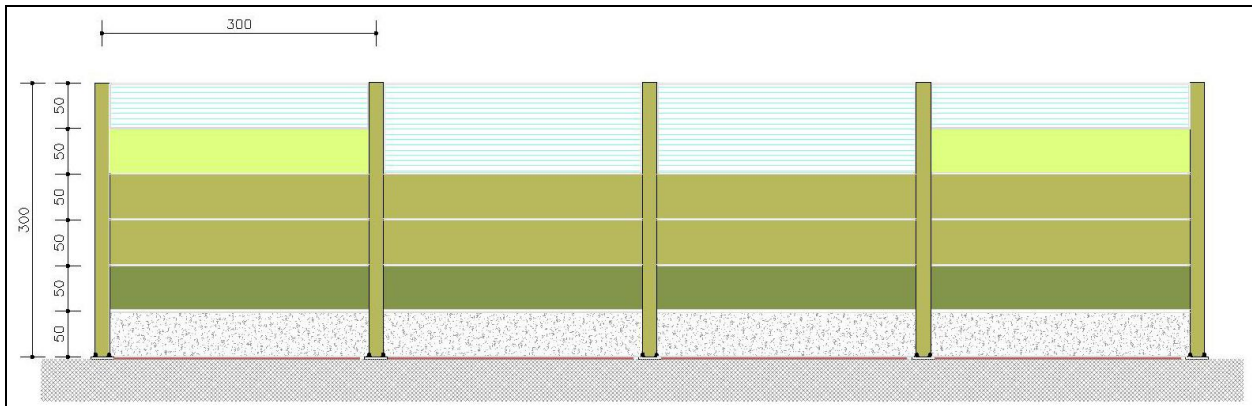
/1: Stralcio di prospetto di barriera antirumore
